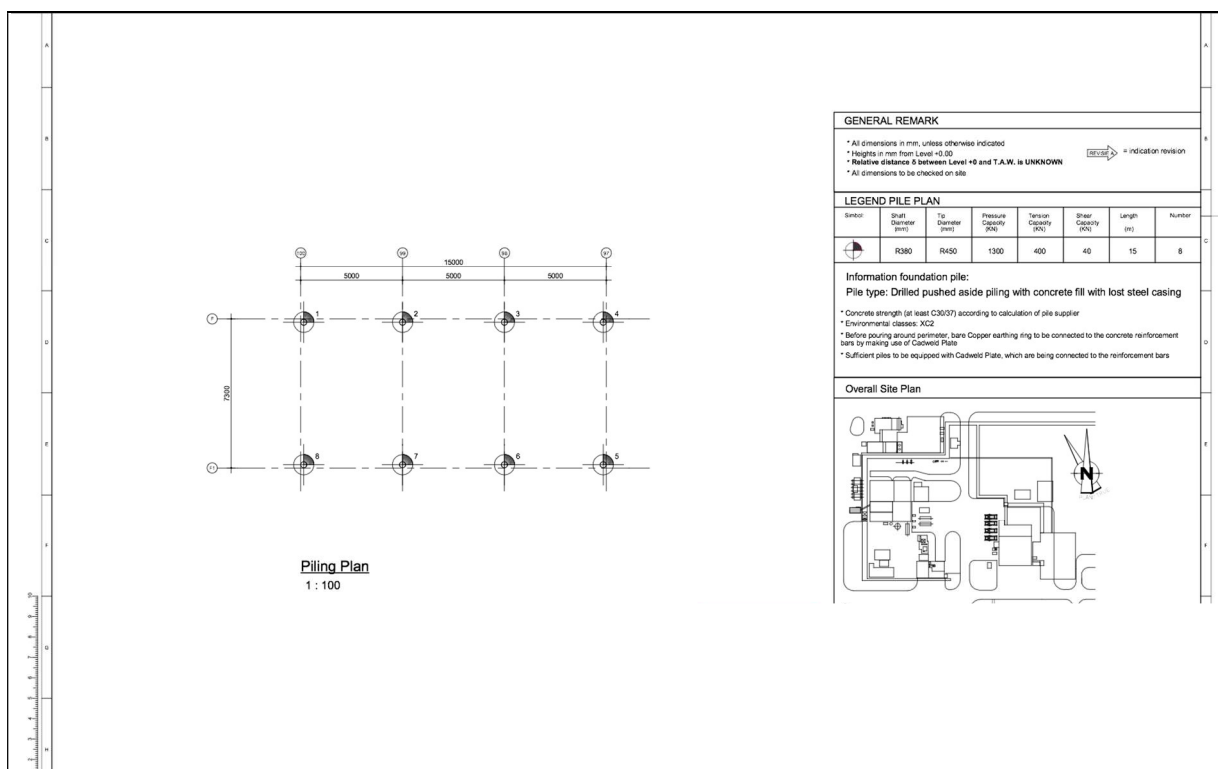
Funderingsplan L1 gebouw (L1 building).
